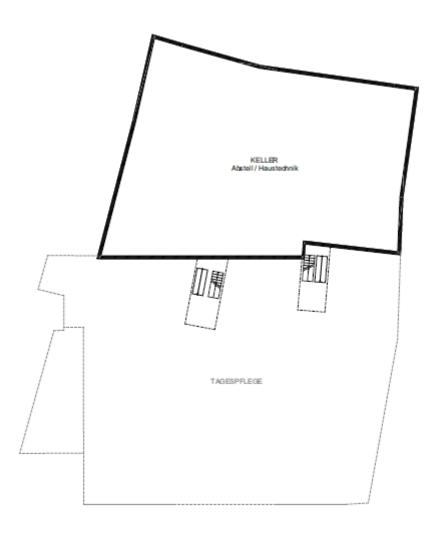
Grundriss 1. Untergeschoss, Kellergeschoss (Mars-Architekten, 2020)
